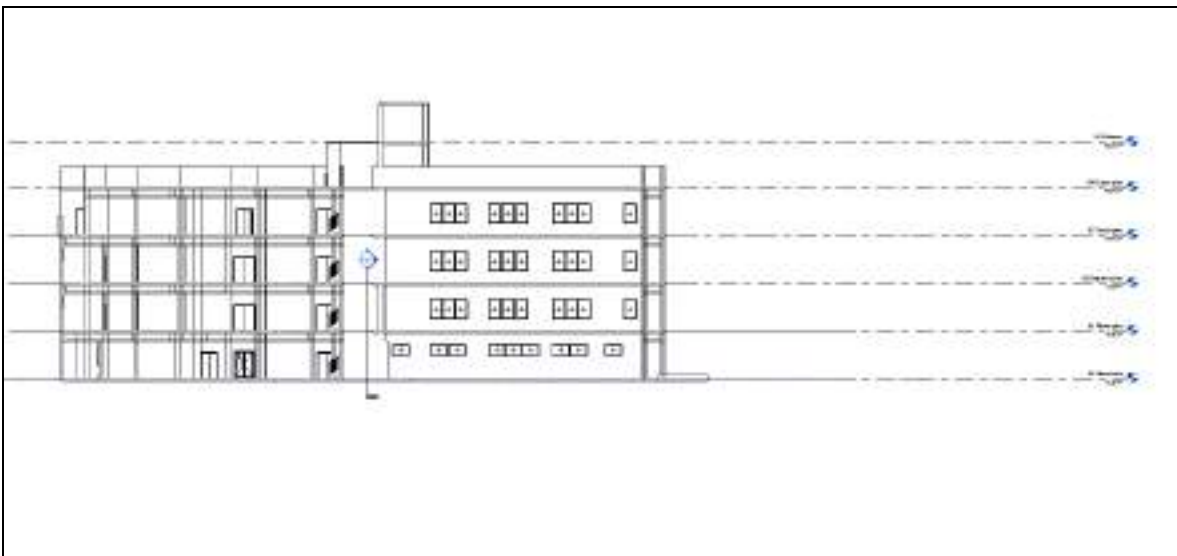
Autodesk Revit - Vista de Corte de Modelo Arquitectónico con Niveles
